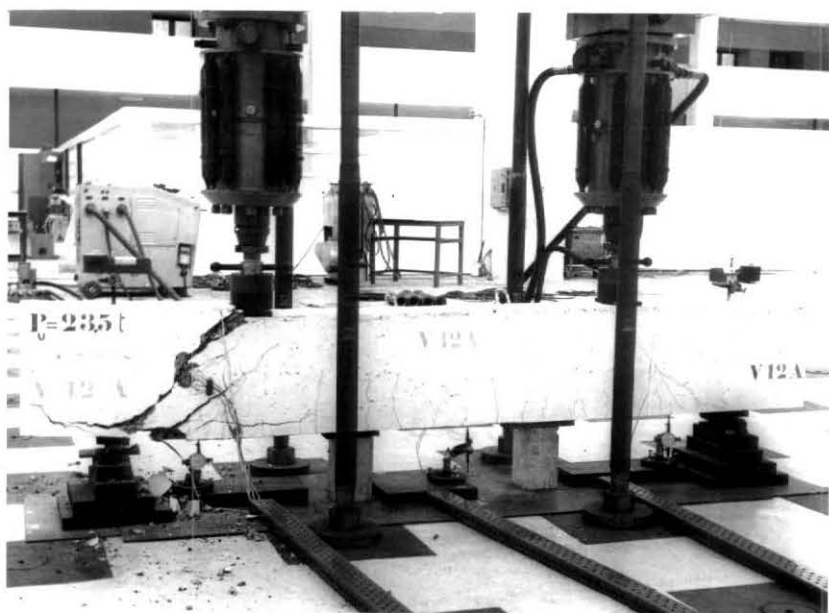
Vista geral da viga 12A ($a/d=1,2$) rompida por esmagamento da biela de concreto.
